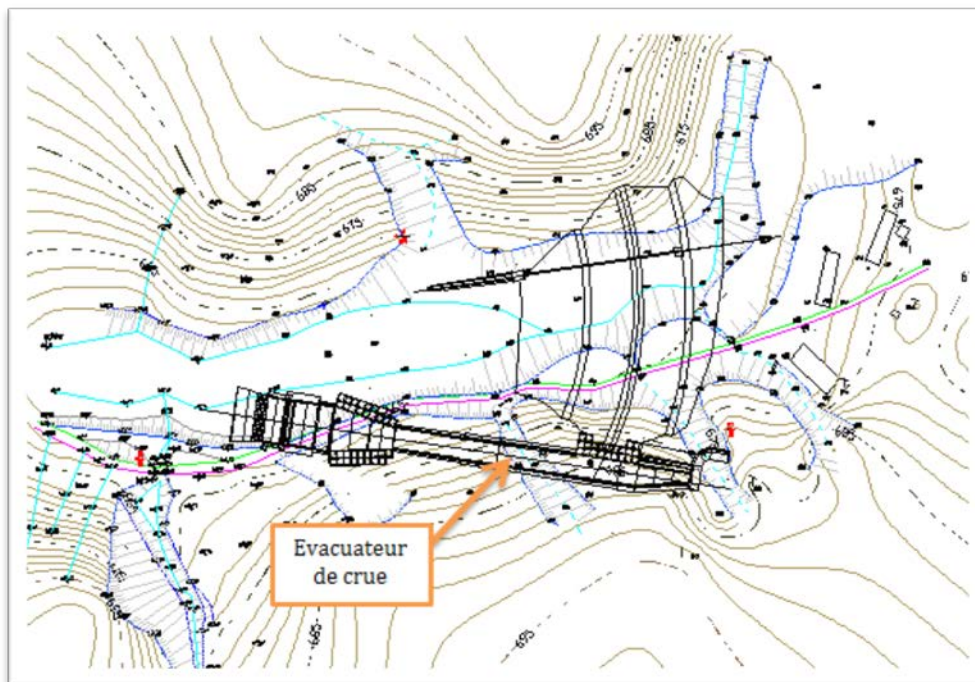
Plans de situation des ouvrages du petit Barrage Tamellahet [25]
